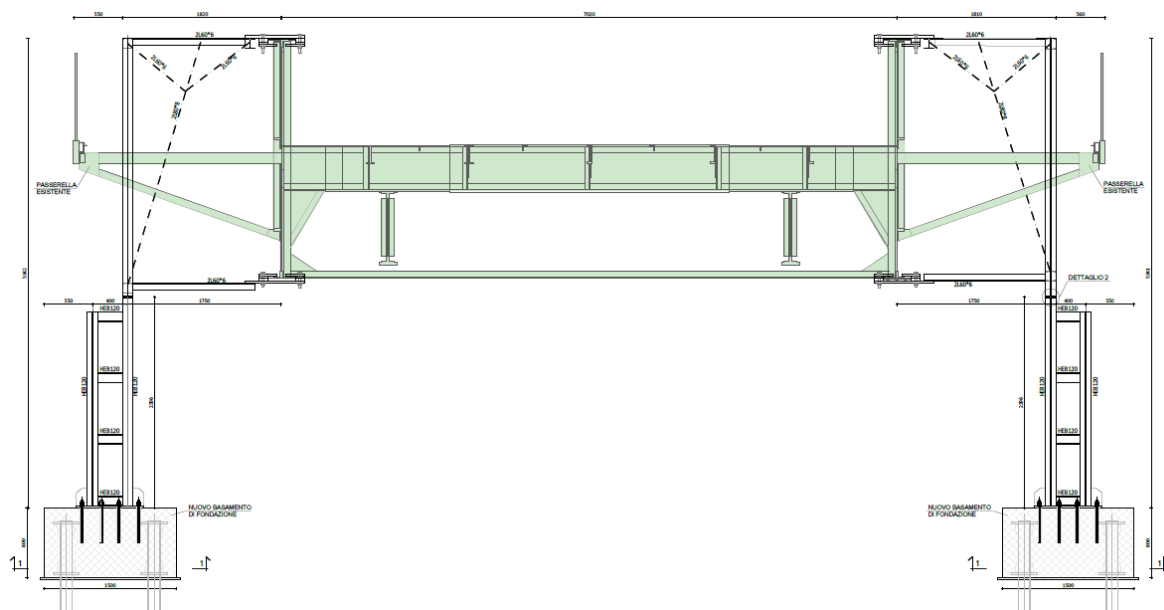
Strutture provvisionali – sezione in corrispondenza delle spalle
